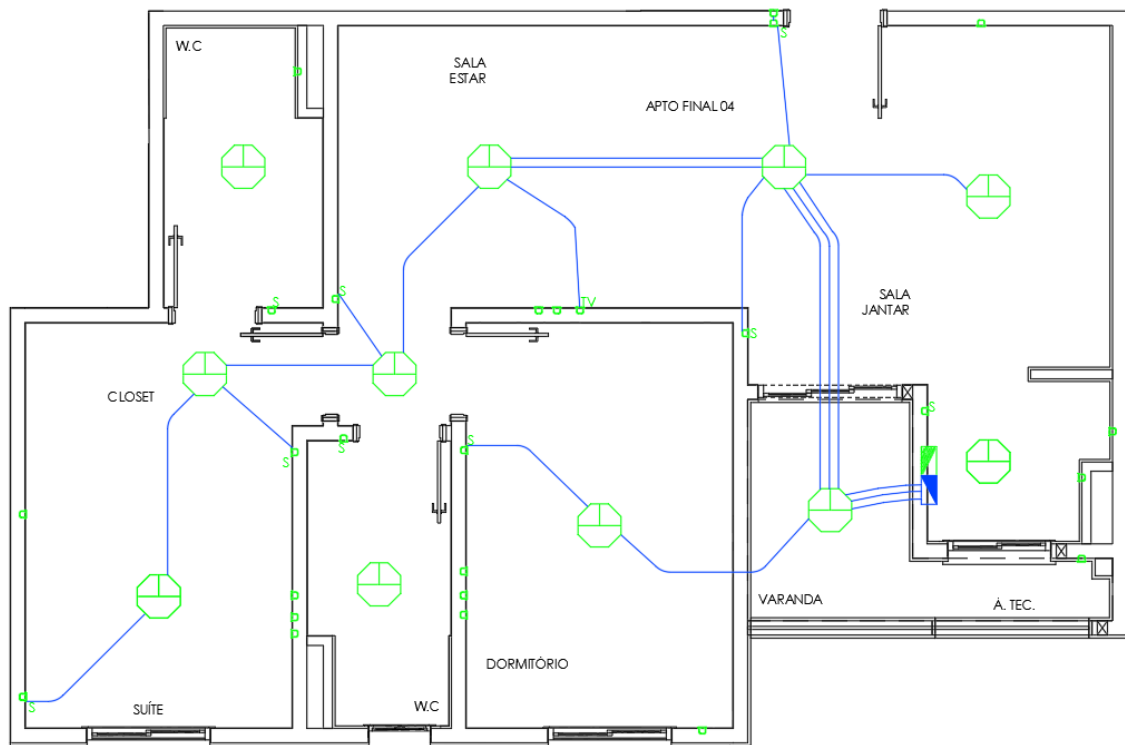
Projeto da infraestrutura de automação do apartamento de 68m² do empreendimento Altos da Avenida, Construtora Santa Angela, Jundiaí, São Paulo (Fonte: Full Control, 2021).
